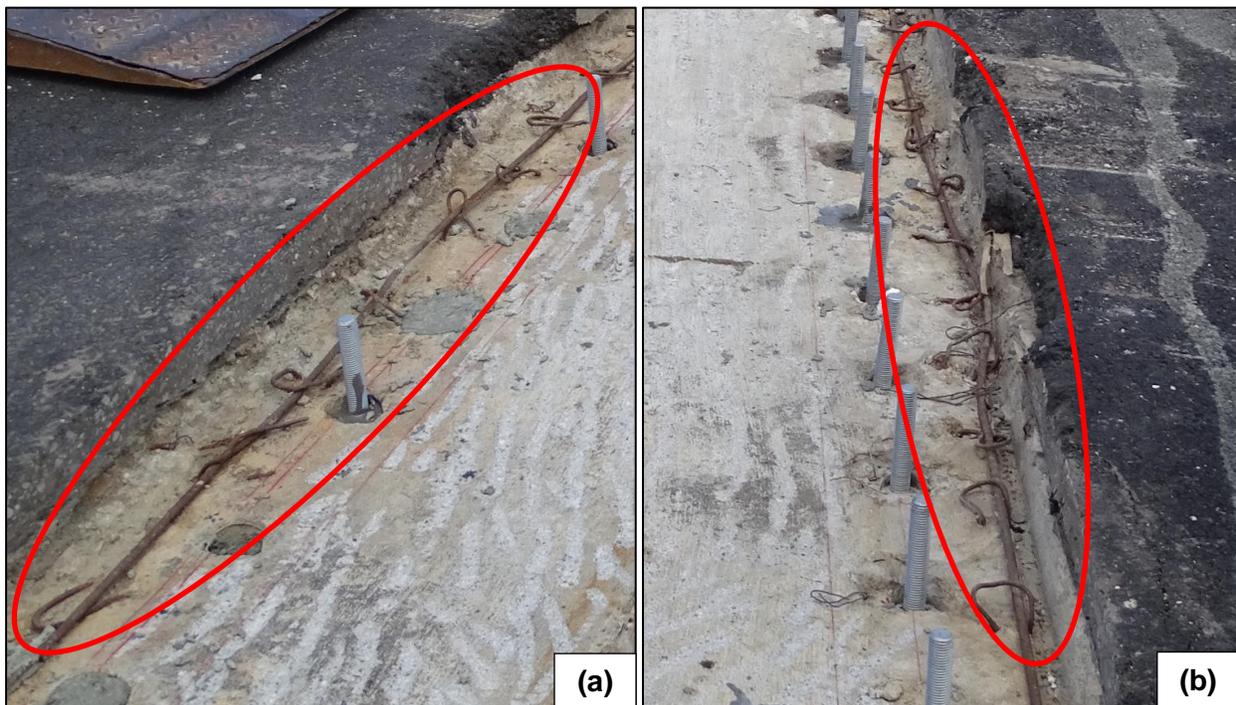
Deformación y desplazamiento del acero de refuerzo colocado en los bordes de la junta de expansión.
